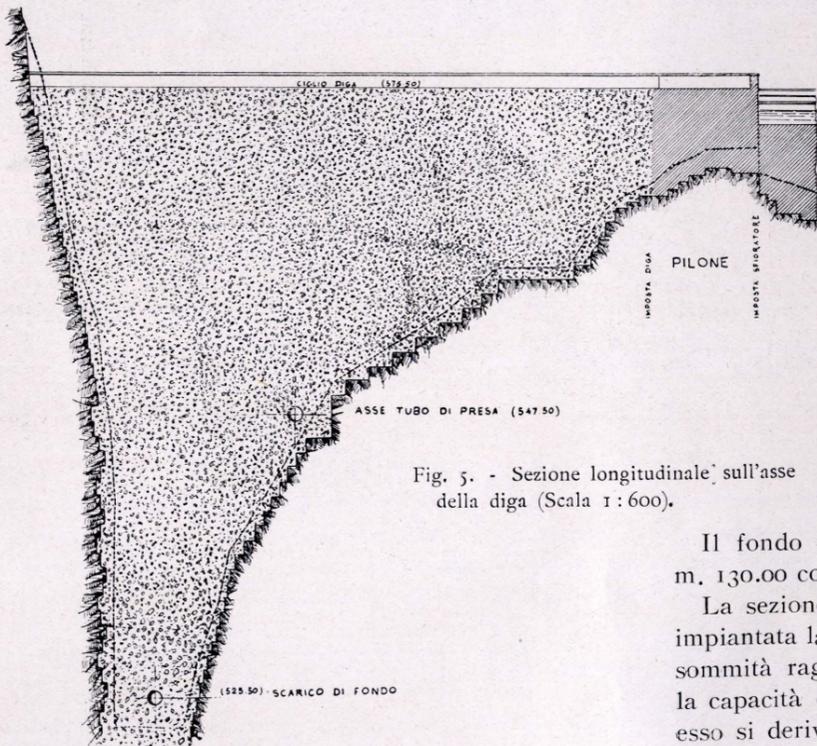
Sezione longitudinale sull'asse della diga (Scala 1:600).
